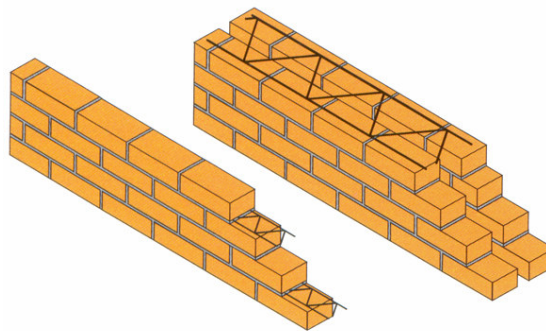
Exemplos da aplicação de armaduras em paredes simples e duplas [14]
